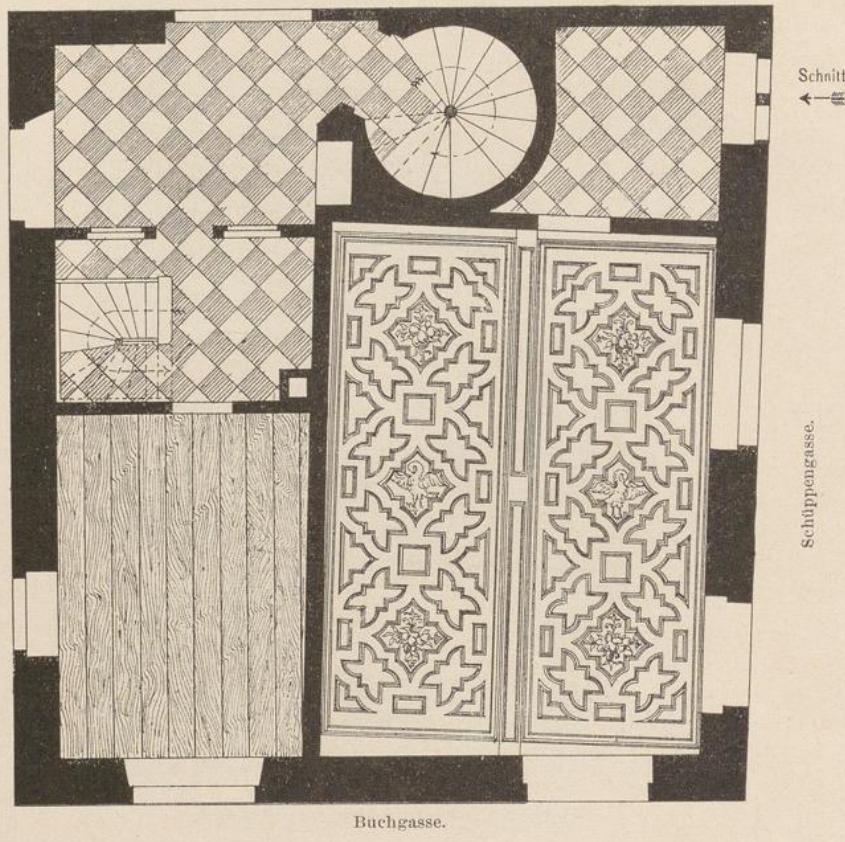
Vogel Strauss; Grundriss des Erdgeschosses.
